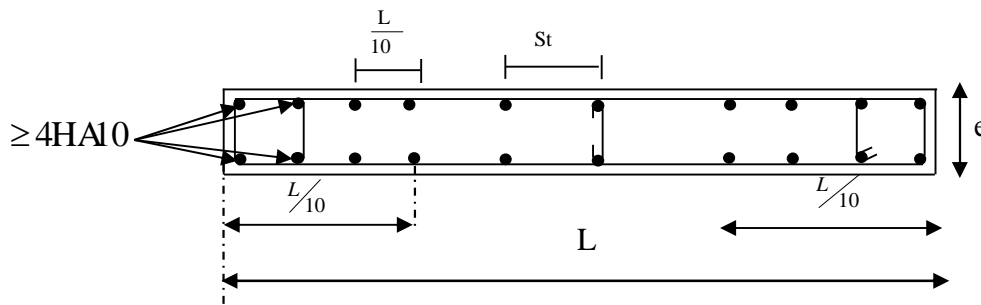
Disposition des armatures verticales dans les voiles.
